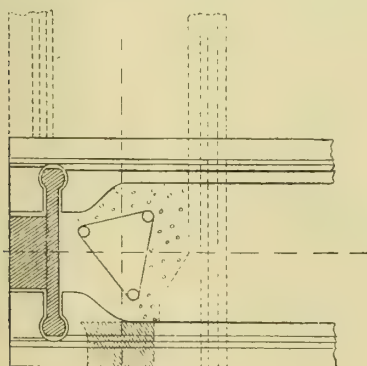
Construction en ciment armé. Briques Stéphane disposées pour un chaînage d'angle. Suppressions des coffrages.
